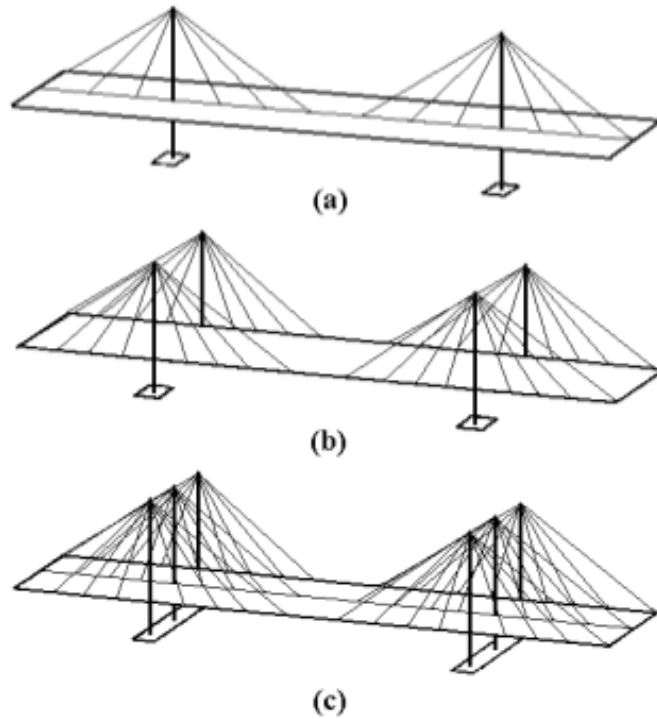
Tipos de Puentes, según el número de planos de atirantamiento (Carrión *et. al.*, 2005)
